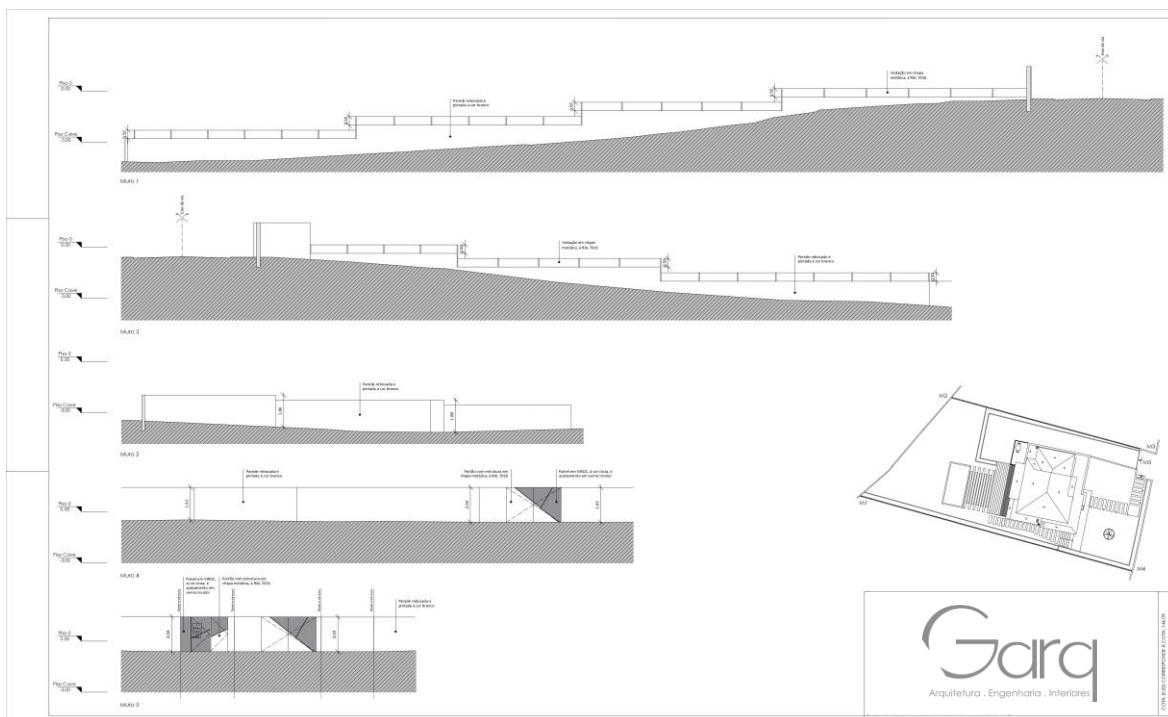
Proposto - Muros de vedação (LIC_R00). Fonte: Garq / Desenvolvimento: Autora.
